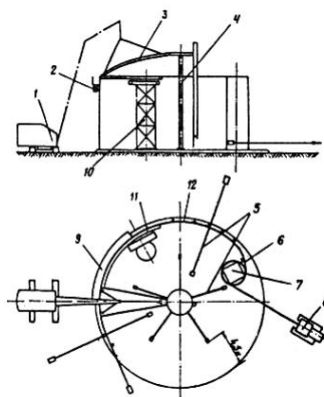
Схема развертывания рулона стенки, установки элементов опорного кольца и кольца жесткости, щитов покрытия: 1 - кран; 2 - навесные леса; 3 - щит покрытия; 4 - монтажная стойка; 5 - расчалки; 6 - клиновой упор; 7 - рулон стенки; 8 - трактор; 9 - кольцо жесткости; 10 - стойка для монтажа опорного кольца; 11 - опорное кольцо; 12 - развернутая часть полотнища стенки
